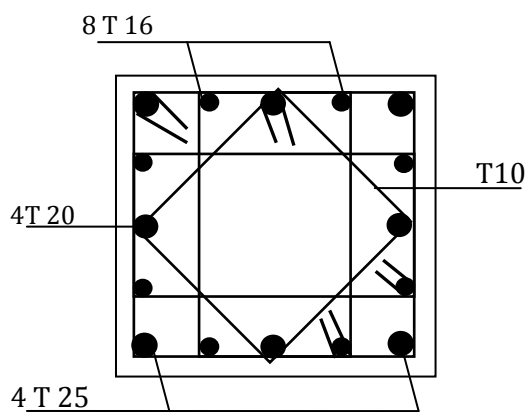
Schéma de ferrailage des poteaux RDC, 1<sup>er</sup> étage.
